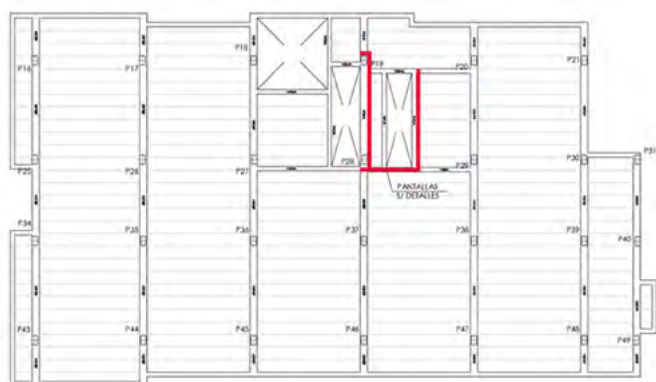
Planta tipo de Milord I (9 plantas) con pantallas de refuerzo.
